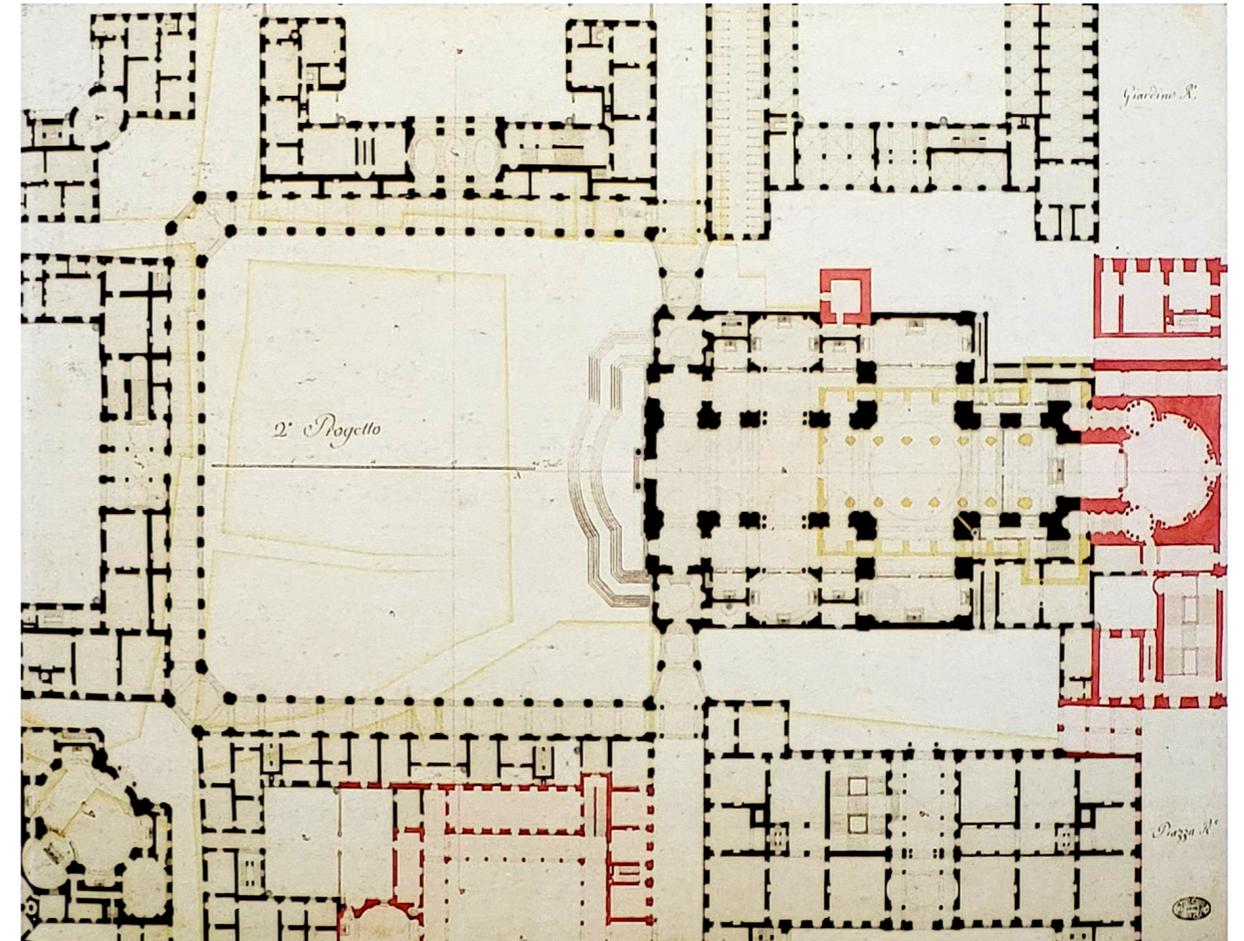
Secondo progetto del Duomo di Torino di Benedetto Alfieri, pianta
